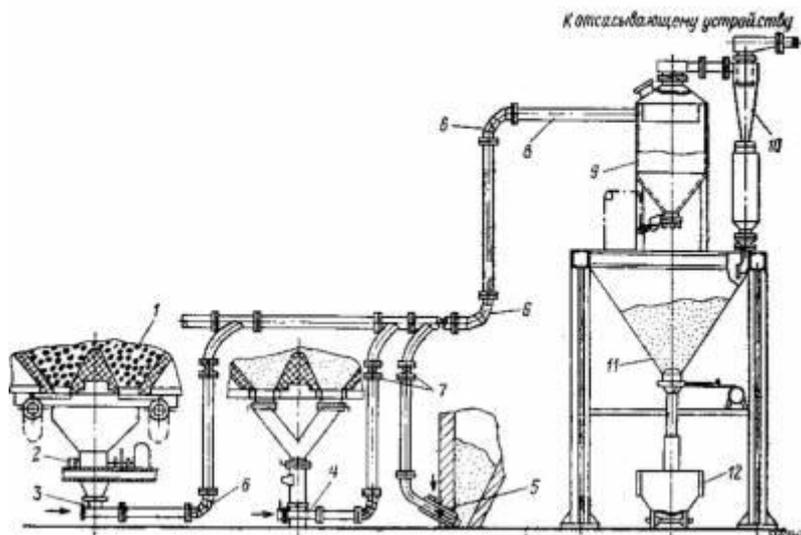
Схема пневматического шлакозолоудаления: 1 — шлаковый бункер; 2 — шлако-дробилка; 3 — насадка для приема шлака; 4 — насадка для приема золы; 5 — телескопическая насадка; 6 — сварное колено; 7 — запорный кран; 8 — шлакозолопровод; 9 — осадительная камера; 10 — циклон; 11 — бункер; 12 — вагон
